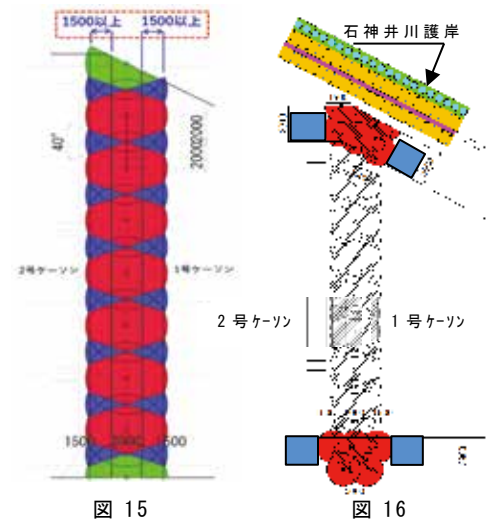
底部地盤改良平面図 図 16 側部地盤改良平面図
